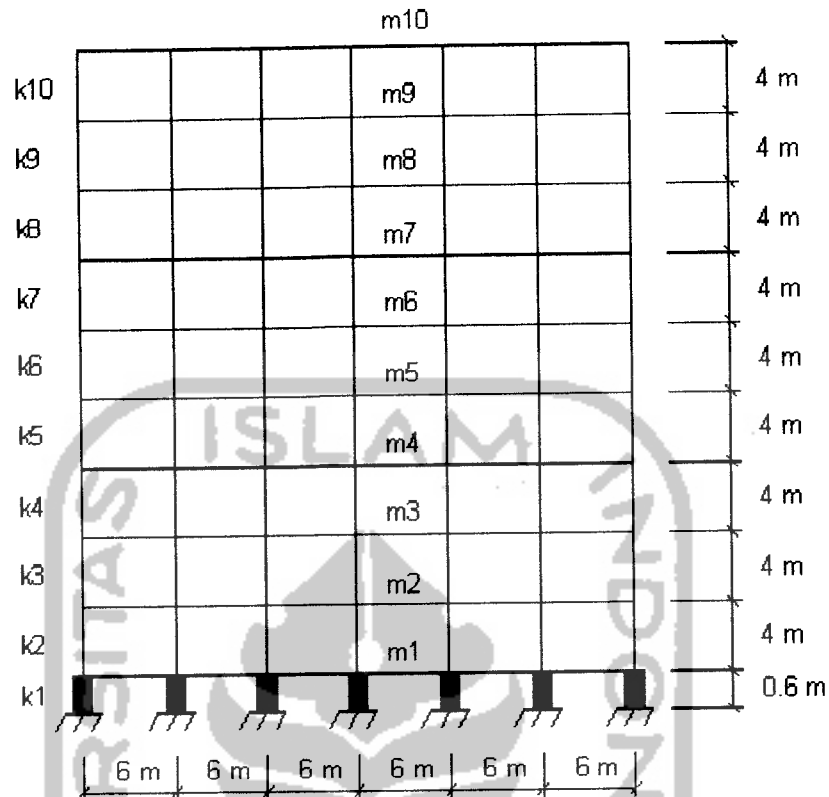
Pemodelan struktur beton bertingkat 10 tanpa *Base isolation
